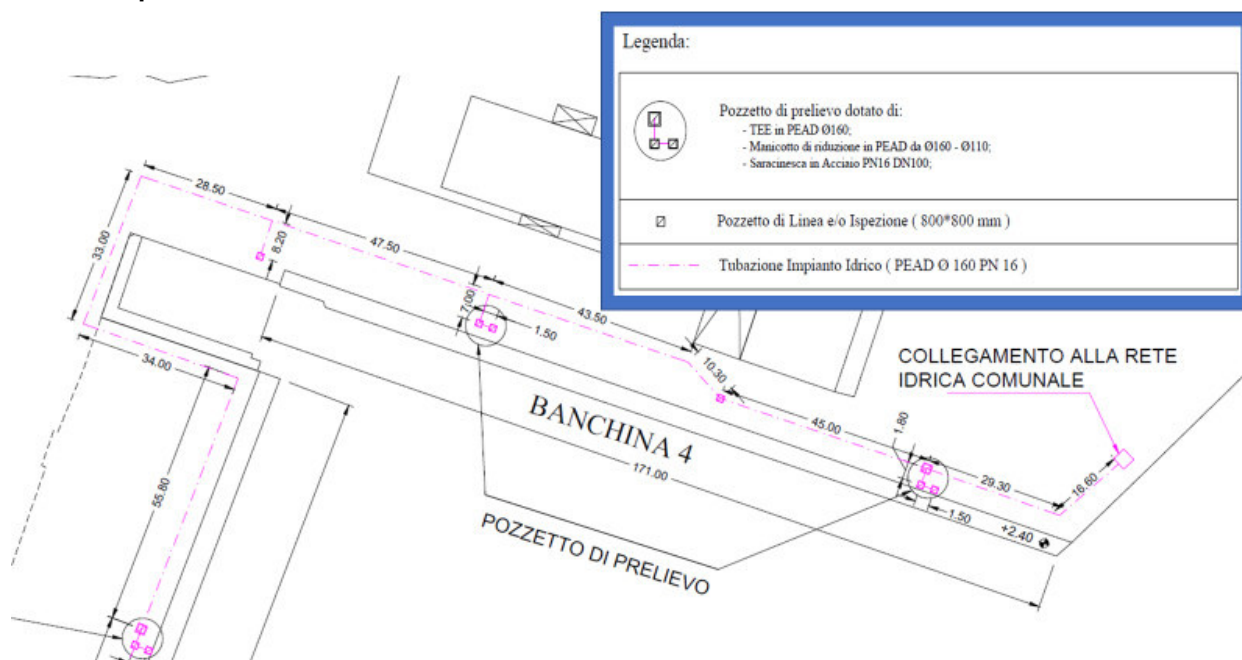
Stralcio planimetria EEG10016T2371- Piazzale IV Novembre e zona cabina CEB
